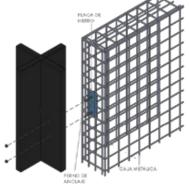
Detalle muro gavión y escombros FUENTE: Autoría propia.
